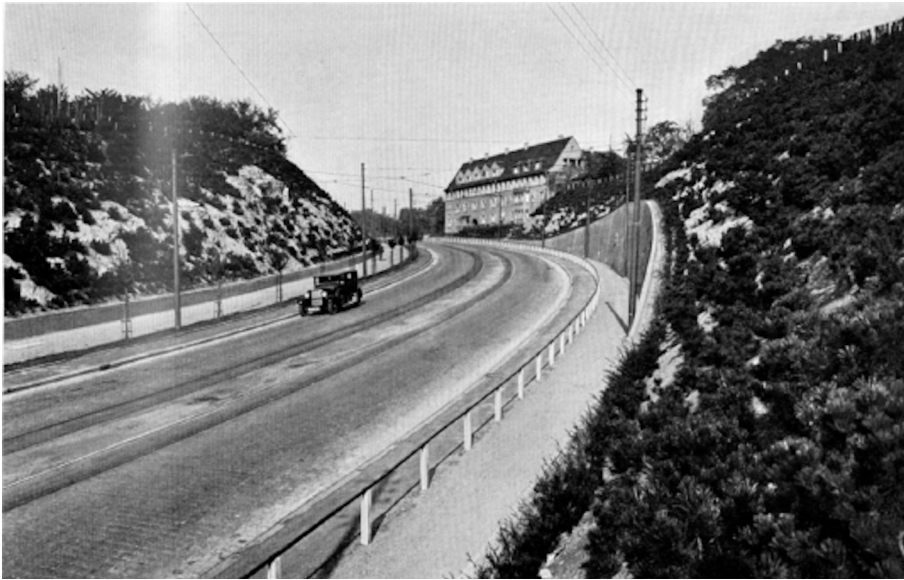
Abschnitt der bis 1930 ausgebauten Heilbronner Straße, einer der wichtigsten Stuttgarter Ausfallstraßen (STAS 183-1/619)
